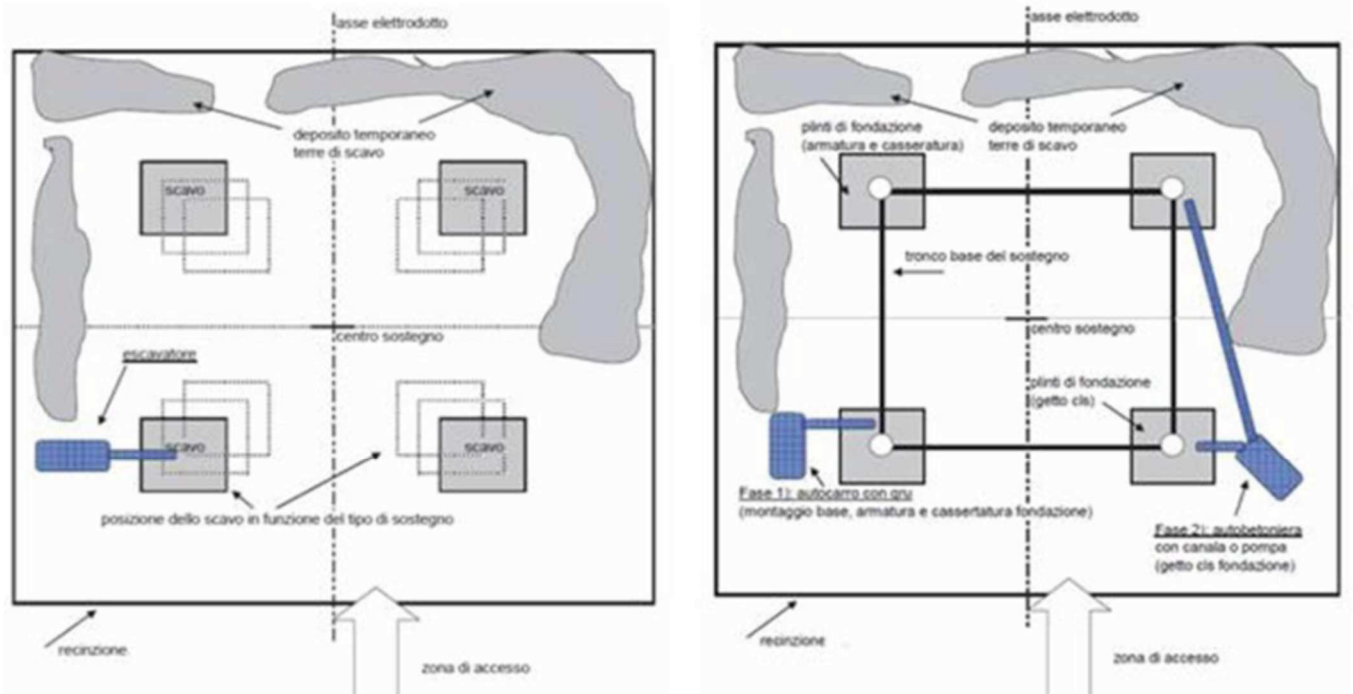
Planimetria tipologia del microcantiere: a sinistra nella fase di scavo delle fondazioni; a destra nella fase di getto per la realizzazione dei piloti di fondazione
